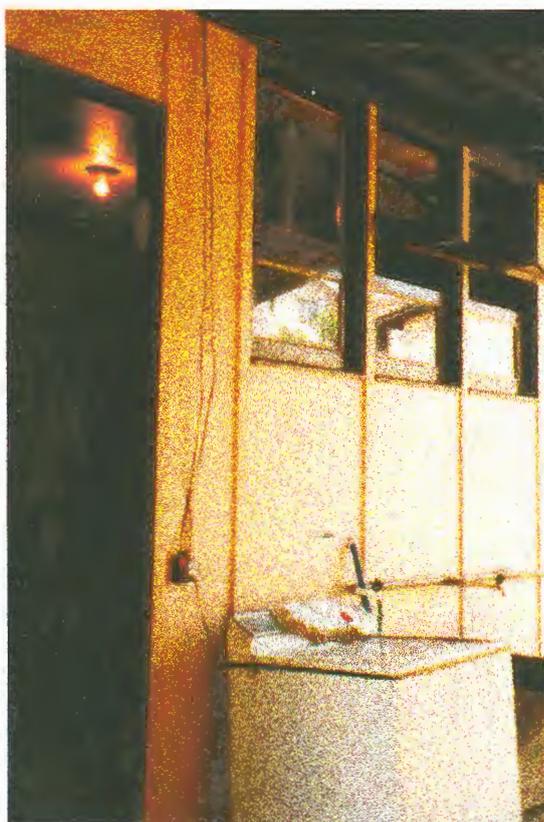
Exemplo de instalações elétricas e hidráulicas para maquina de lavar roupas.
